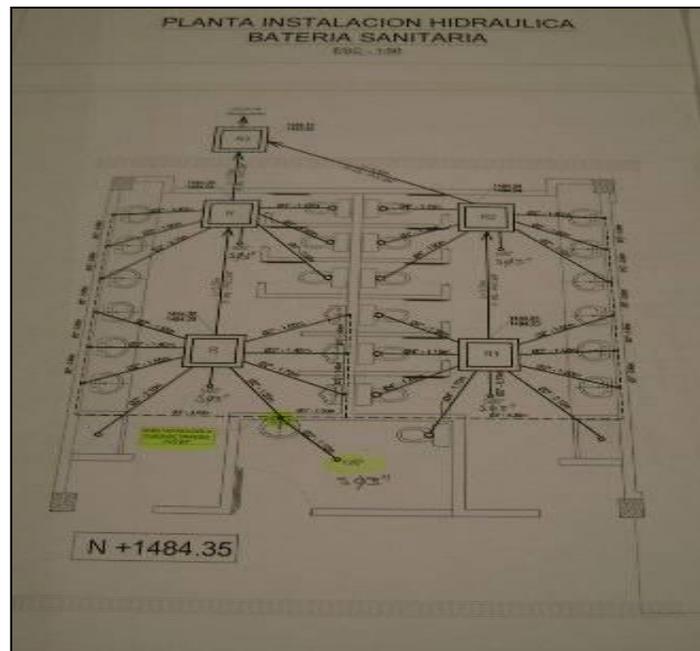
Diseño de instalación hidráulica y batería sanitaria
